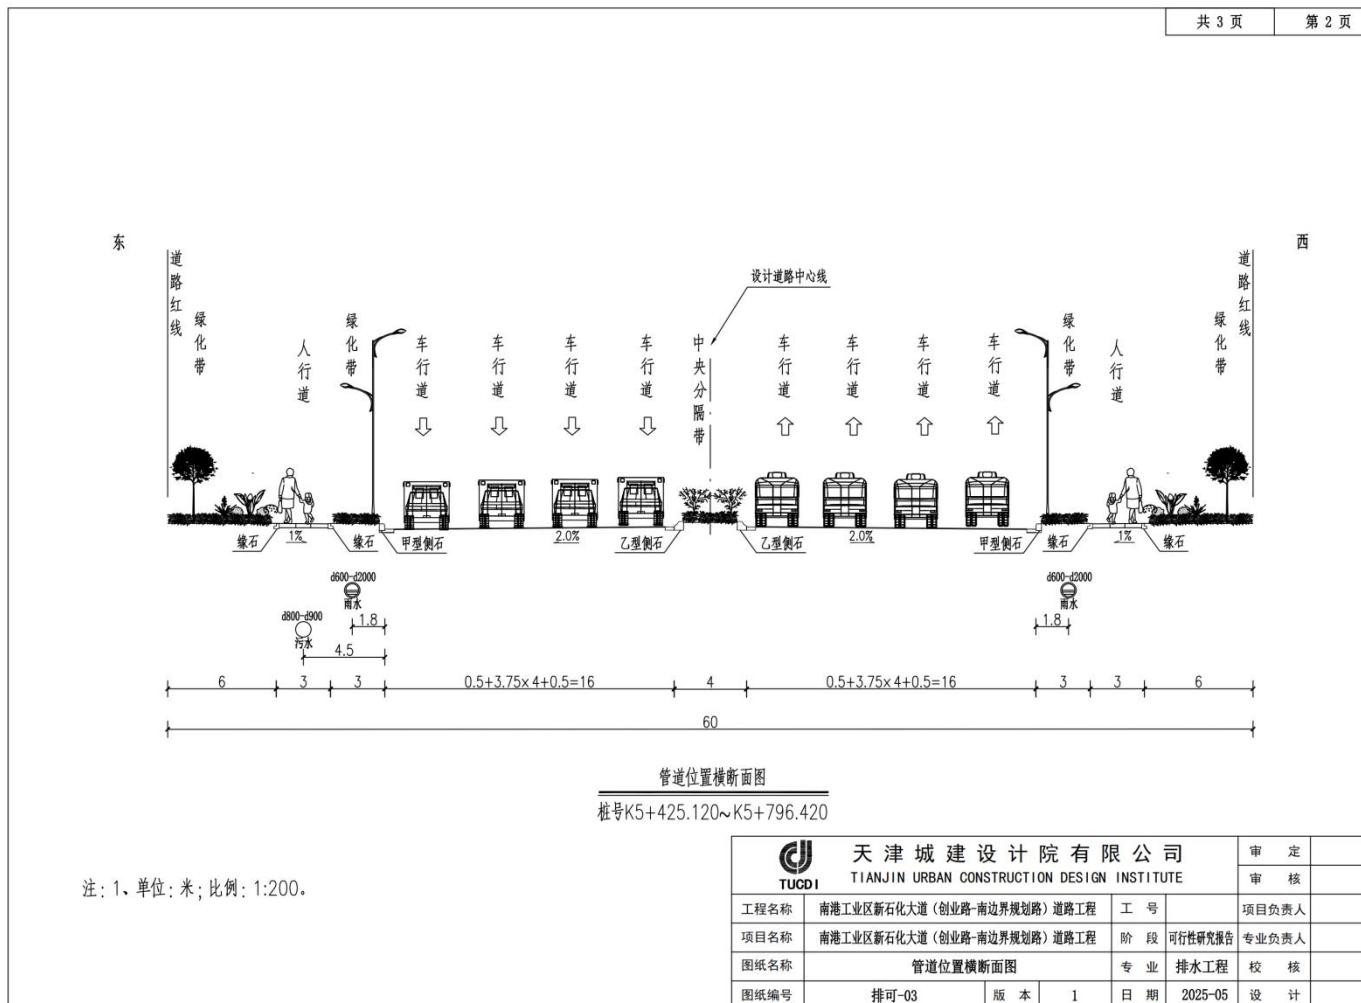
桩号 K5+425.120~K5+796.420 段雨水、污水排放管道工程断面图
